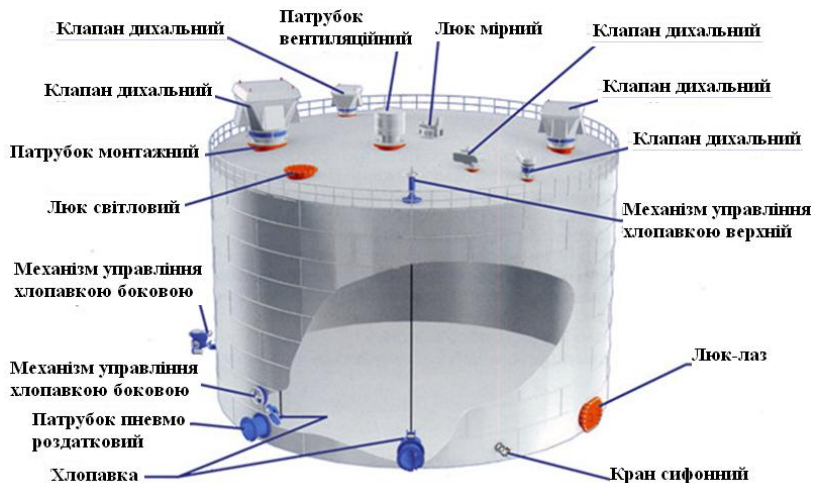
Обладнання циліндричного резервуара для зберігання нафти
